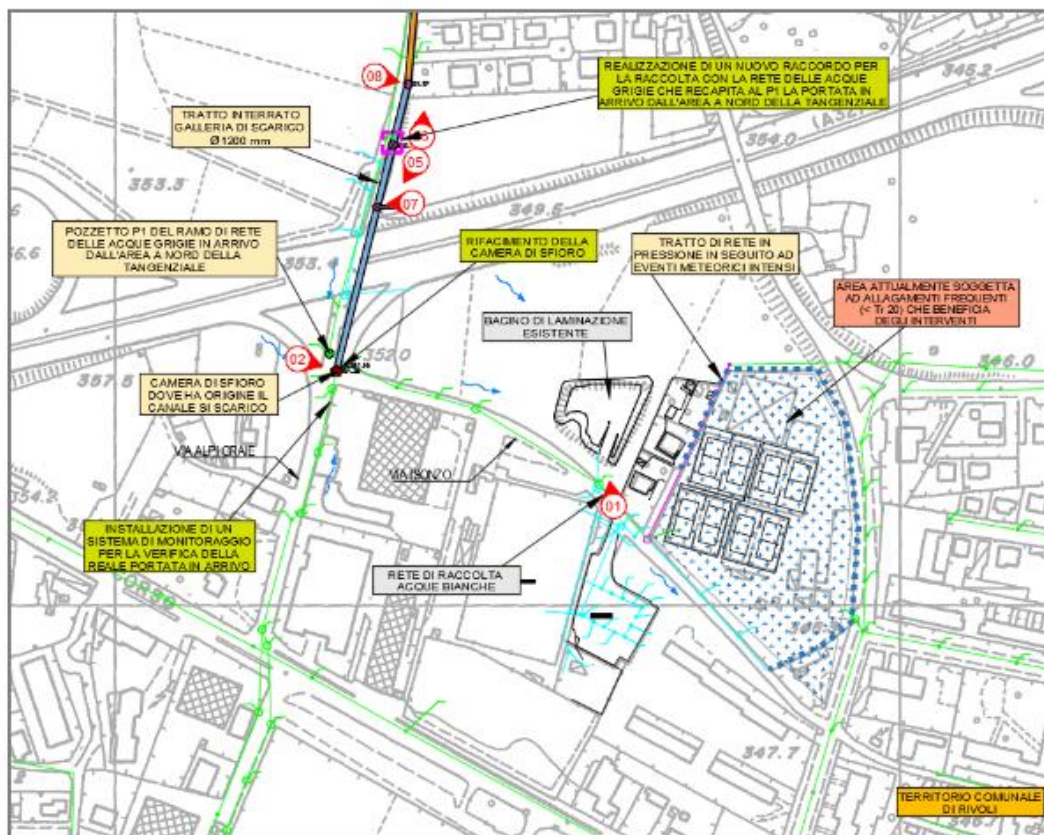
Estratto dell'elab. 15 – Quadro delle criticità e planimetria di progetto. Sono evidenziate le aree soggette ad allagamenti in accordo con la documentazione fotografica riportata e quanto indicato dai tecnici comunali.
